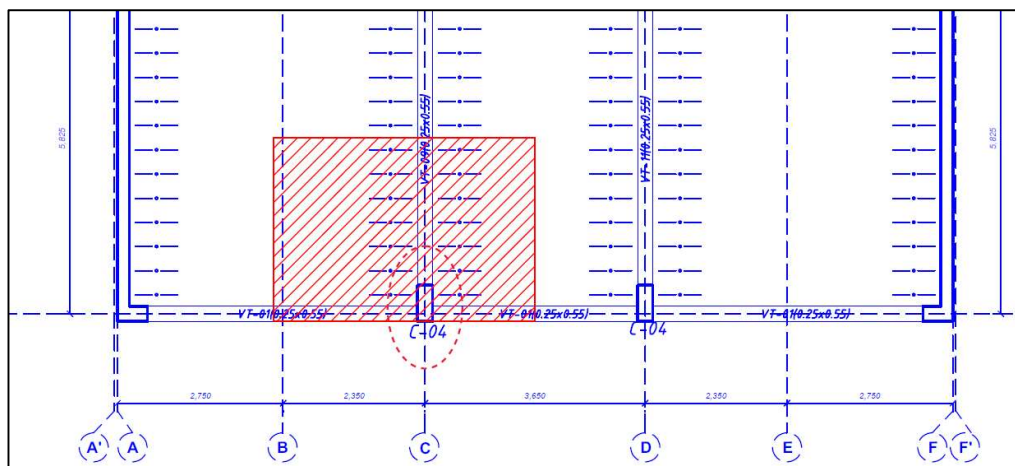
Vista en planta de columna C04 (Eje C-2)
